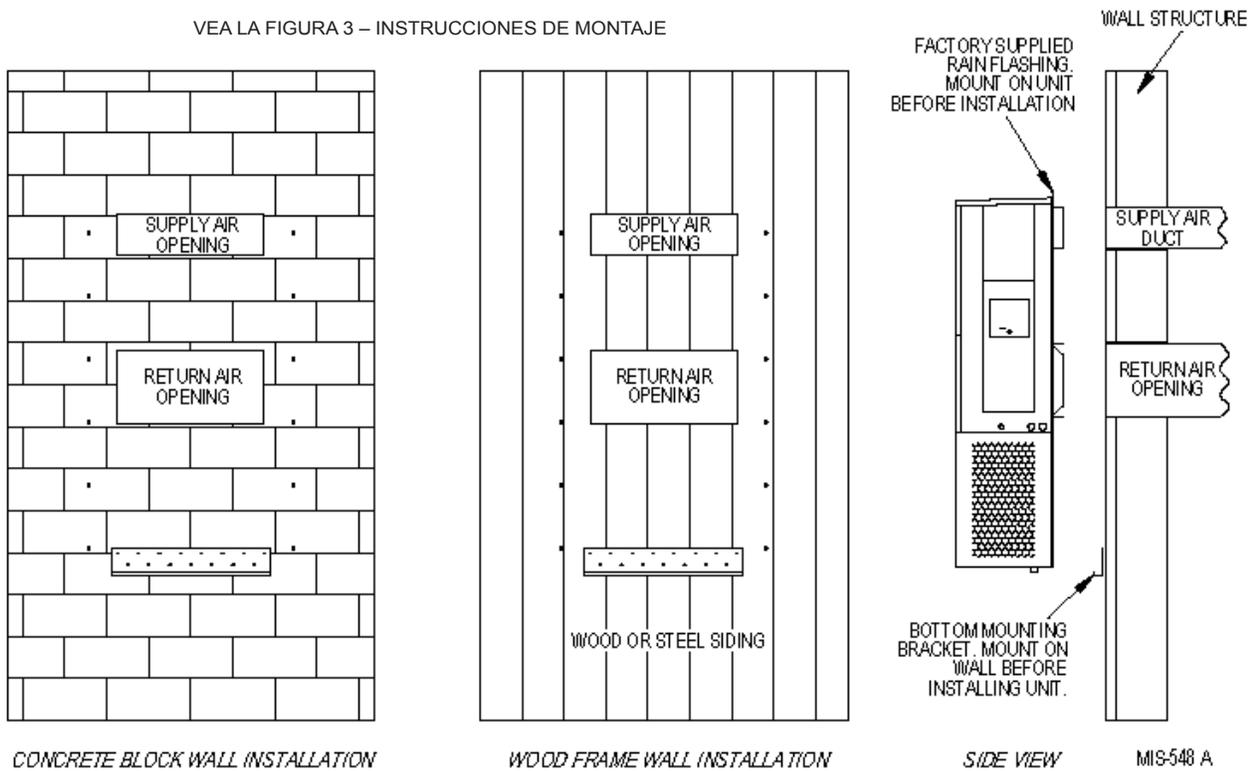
INSTRUCCIONES DE MONTAJE EN LA PARED
